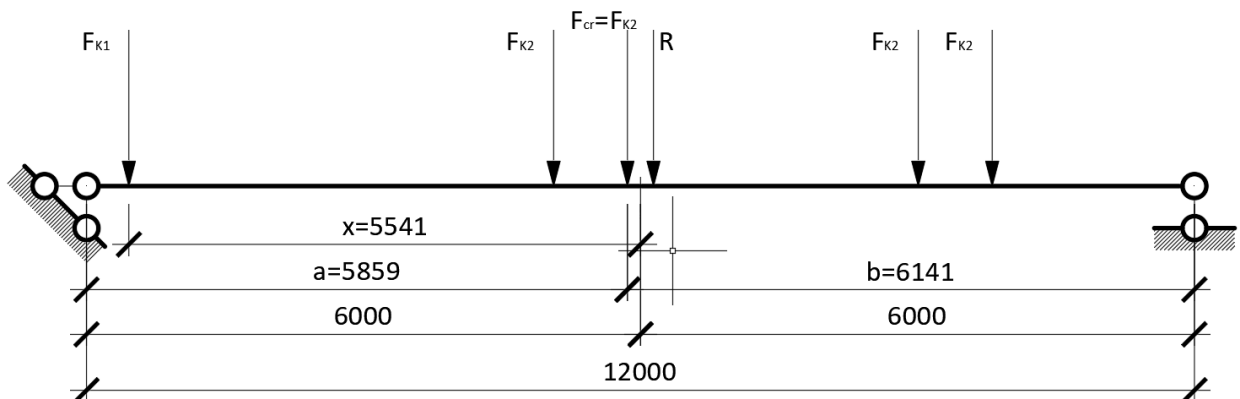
Розрахункова схема навантаження підкранової балки
